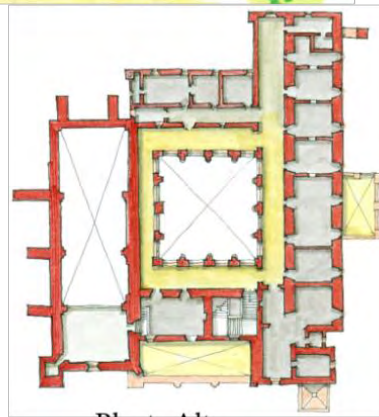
Tepoztlán, Mor. Ex convento La Natividad. Planta arquitectónica. TMH Plumón sobre sketch
